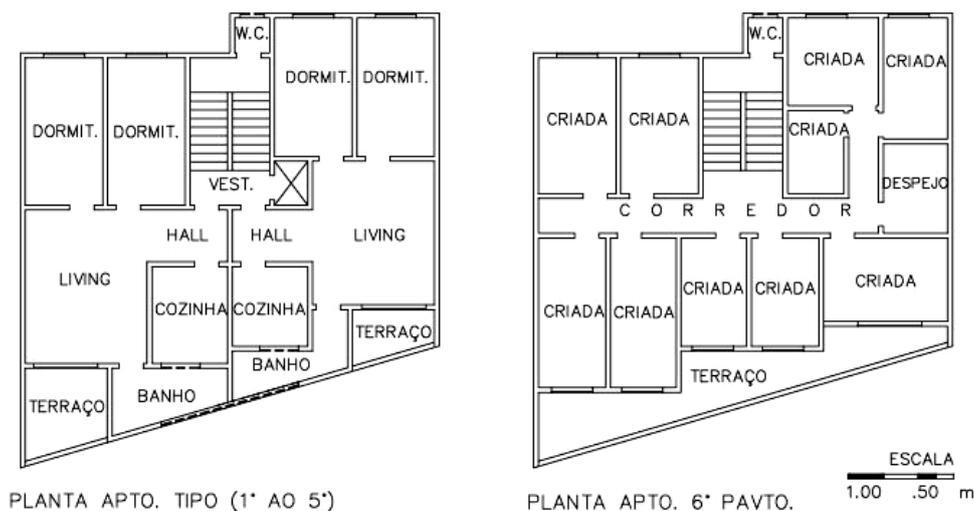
PLANTAS TIPO DO EDIFÍCIO ANGÉLICA
